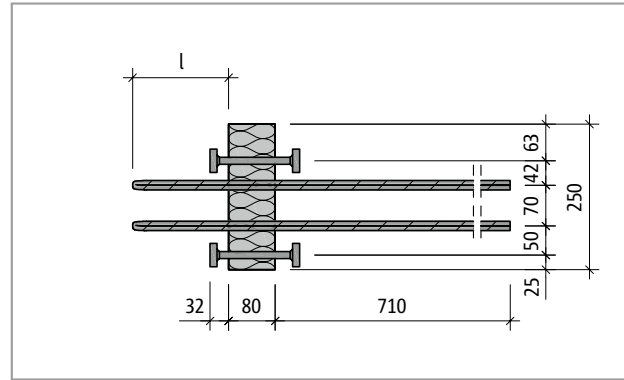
Schöck Isokorb® T Typ O-X80: Produktgrundriss
